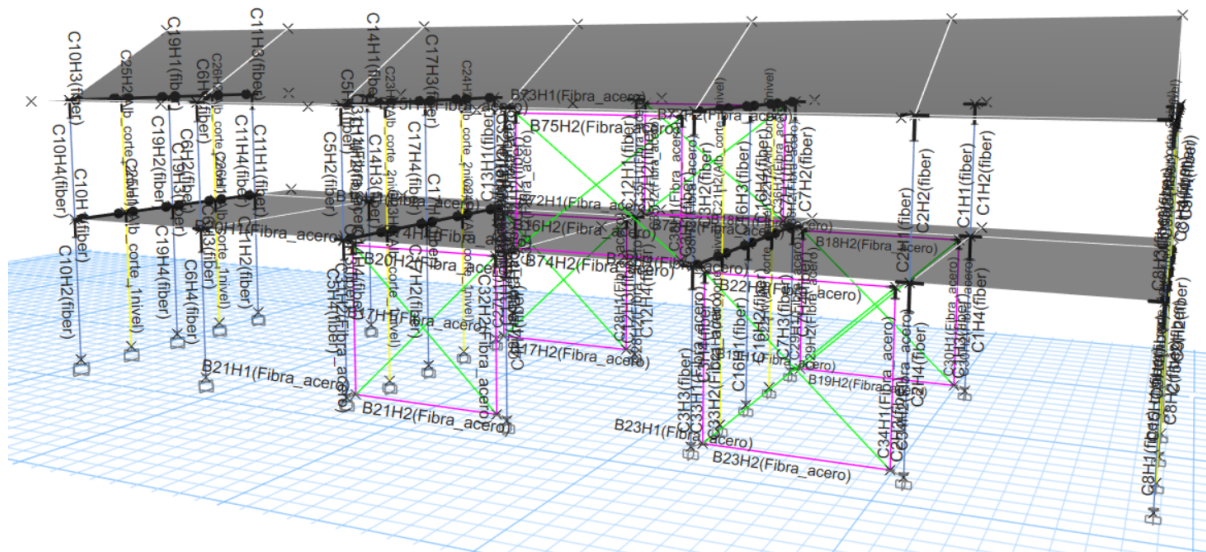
Modelo reforzado con rótulas en vigas y columnas
